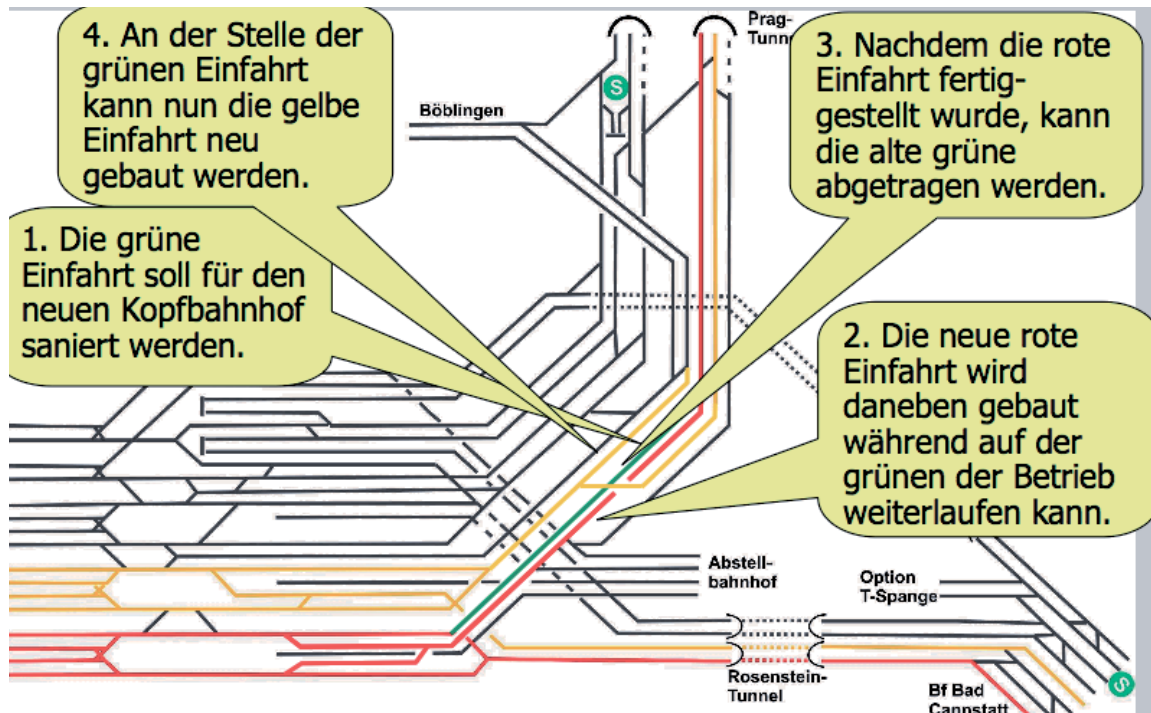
Optimierter Stuttgarter Kopfbahnhof als Alternative zu Stuttgart 21: Bauen während laufendem Bahnbetrieb
